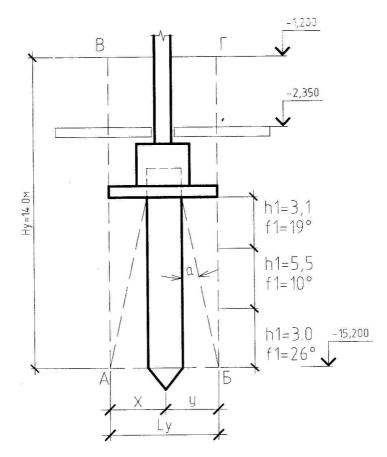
Схема свайного фундамента для расчета по второй группе предельных состояний
